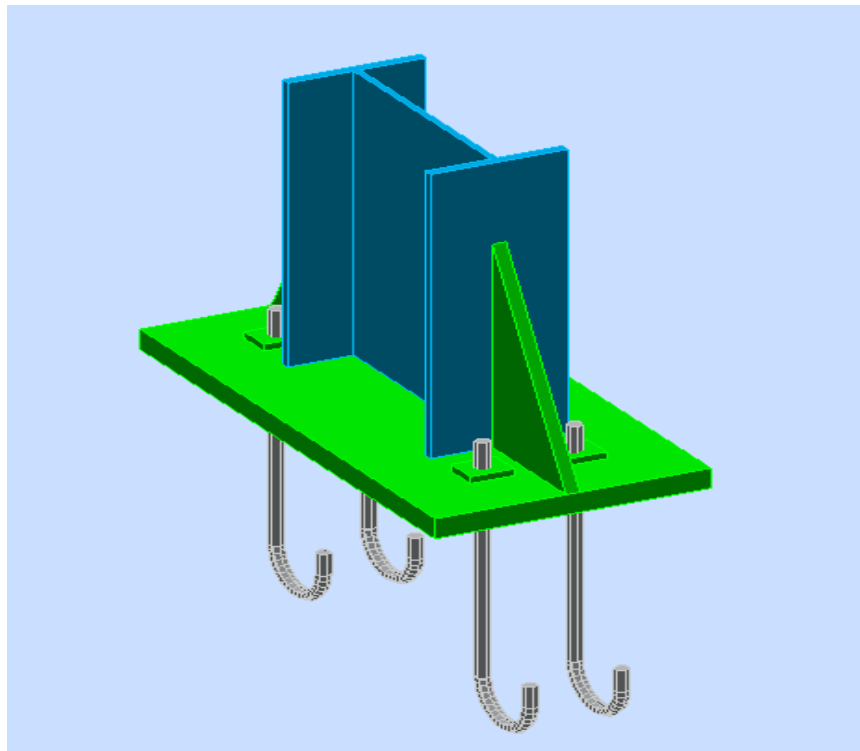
Vue en 3D des assemblages des pieds de poteau
